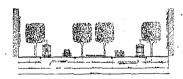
Coupe transversale d'une voie de 40 mètres.
